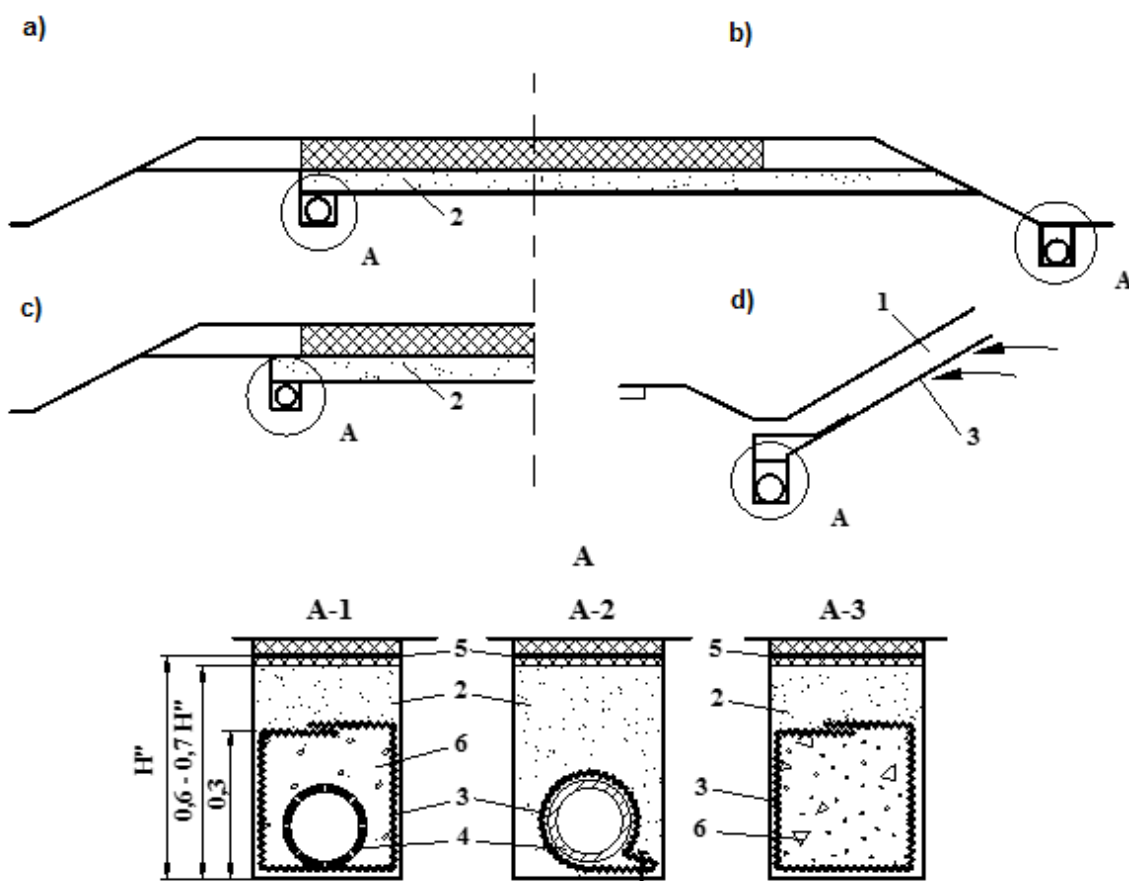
Structurile drenajelor longitudinale cu utilizarea MG
